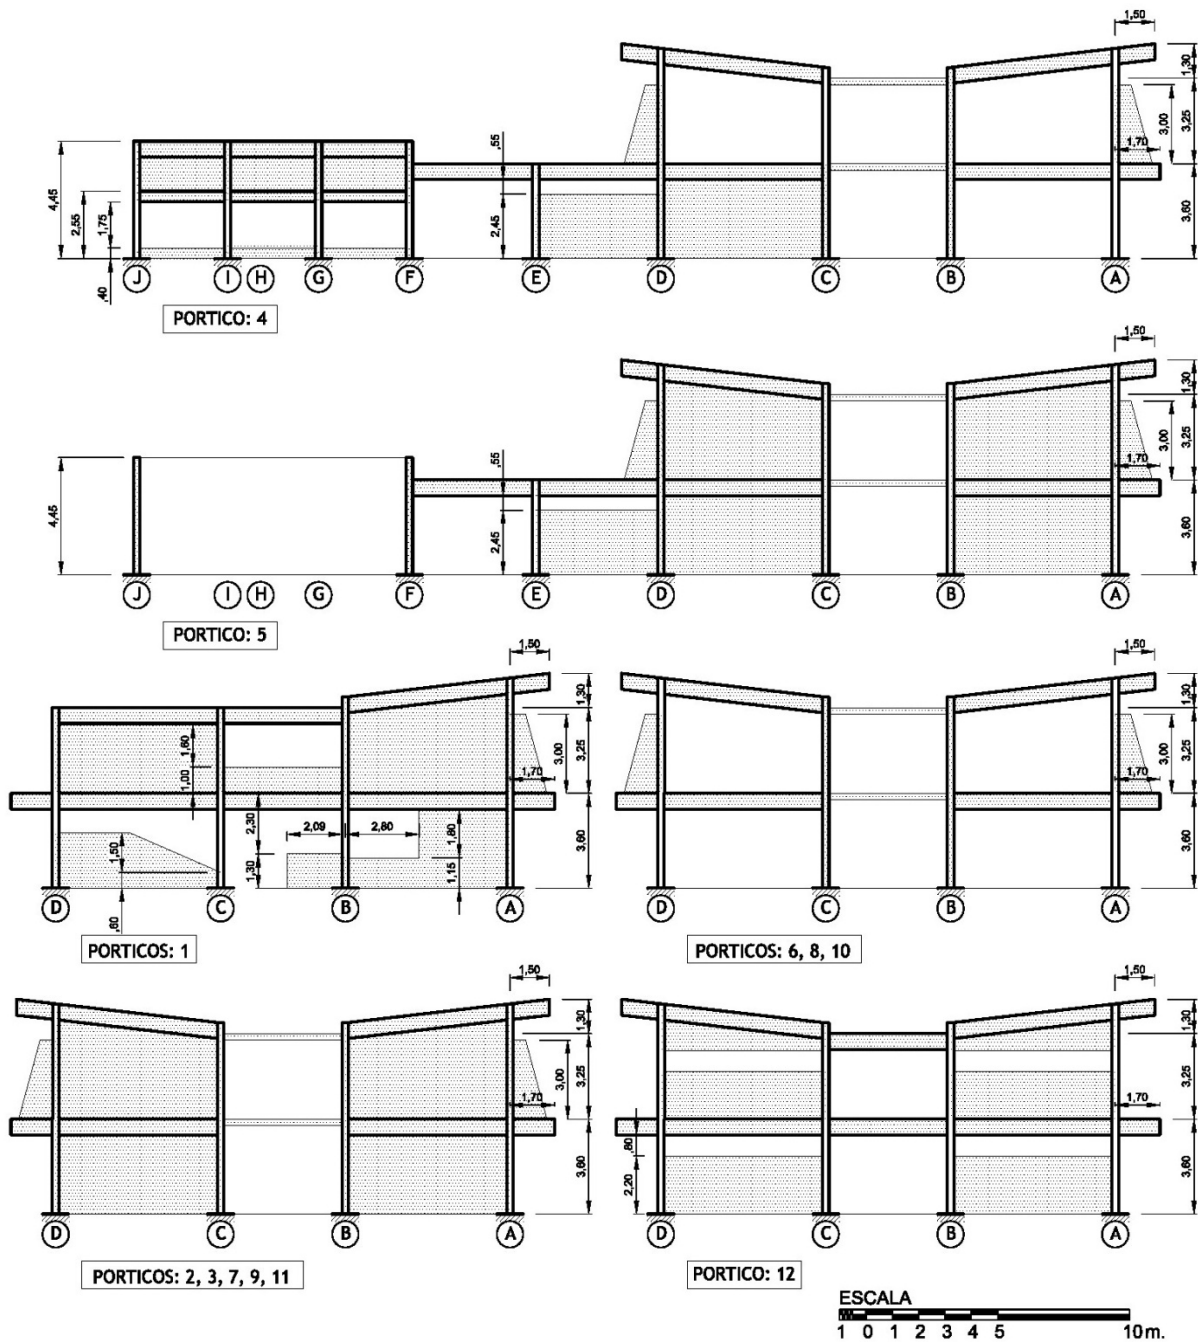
Pórticos transversales (X) del Módulo Principal mostrando las paredes de mampostería y la longitud efectiva de las columnas.
